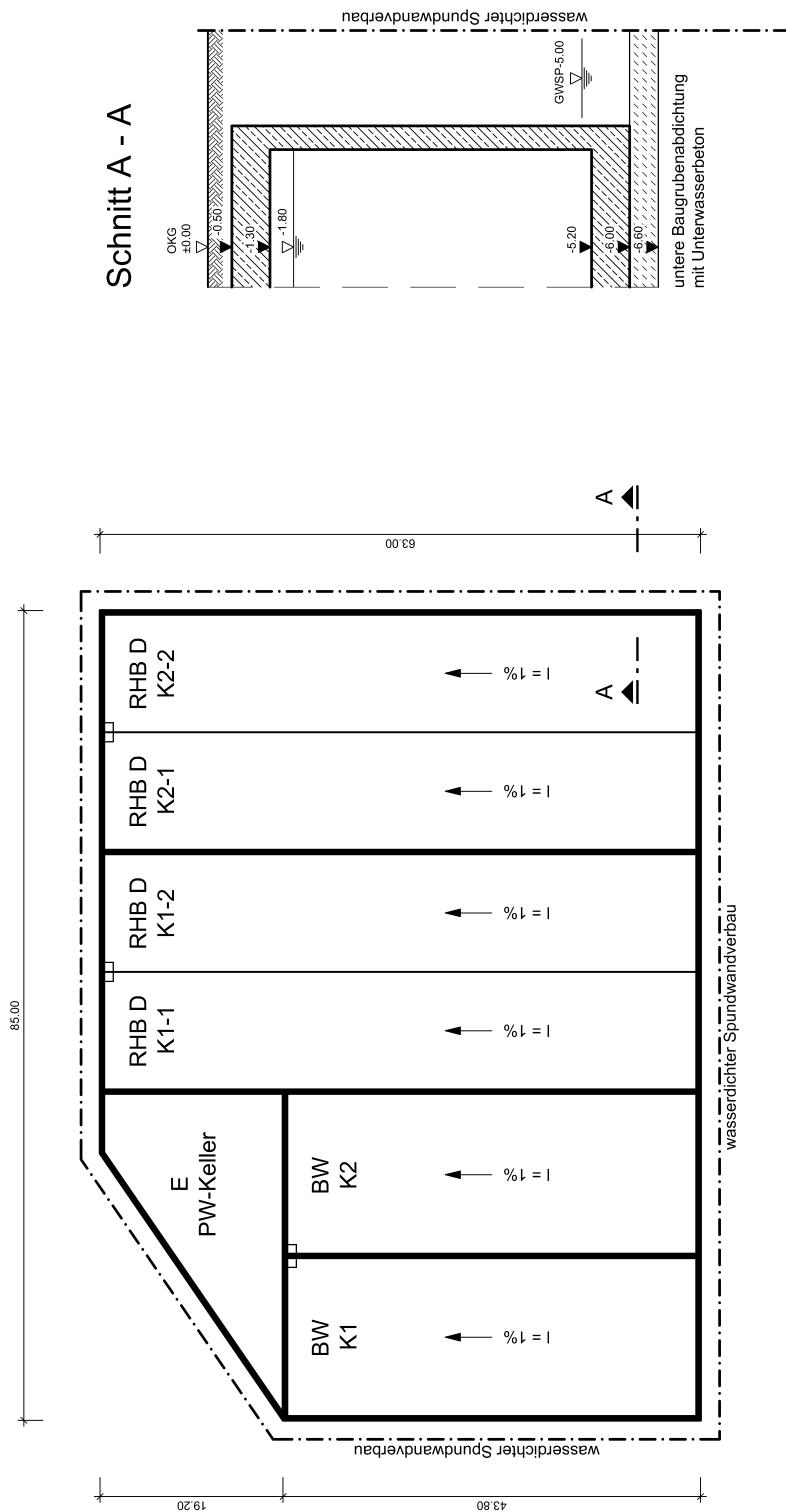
Grundriss und Schnitt RHB D sowie Grundriss Brauchwasserspeicher
